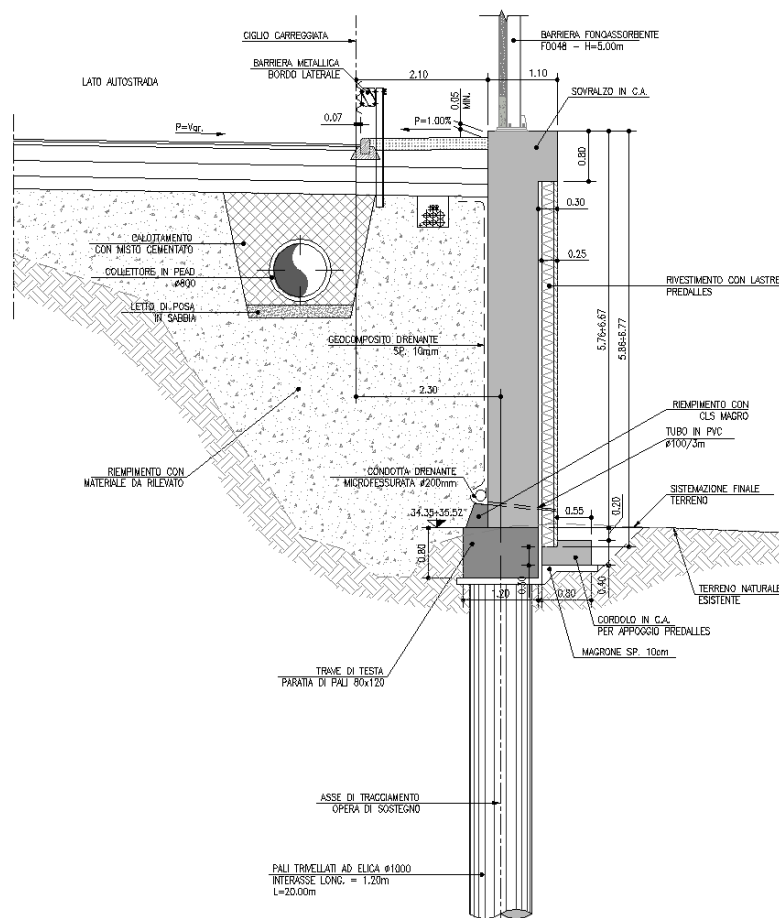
Sezione tipo opera di sostegno MS010 – Tratto 2
